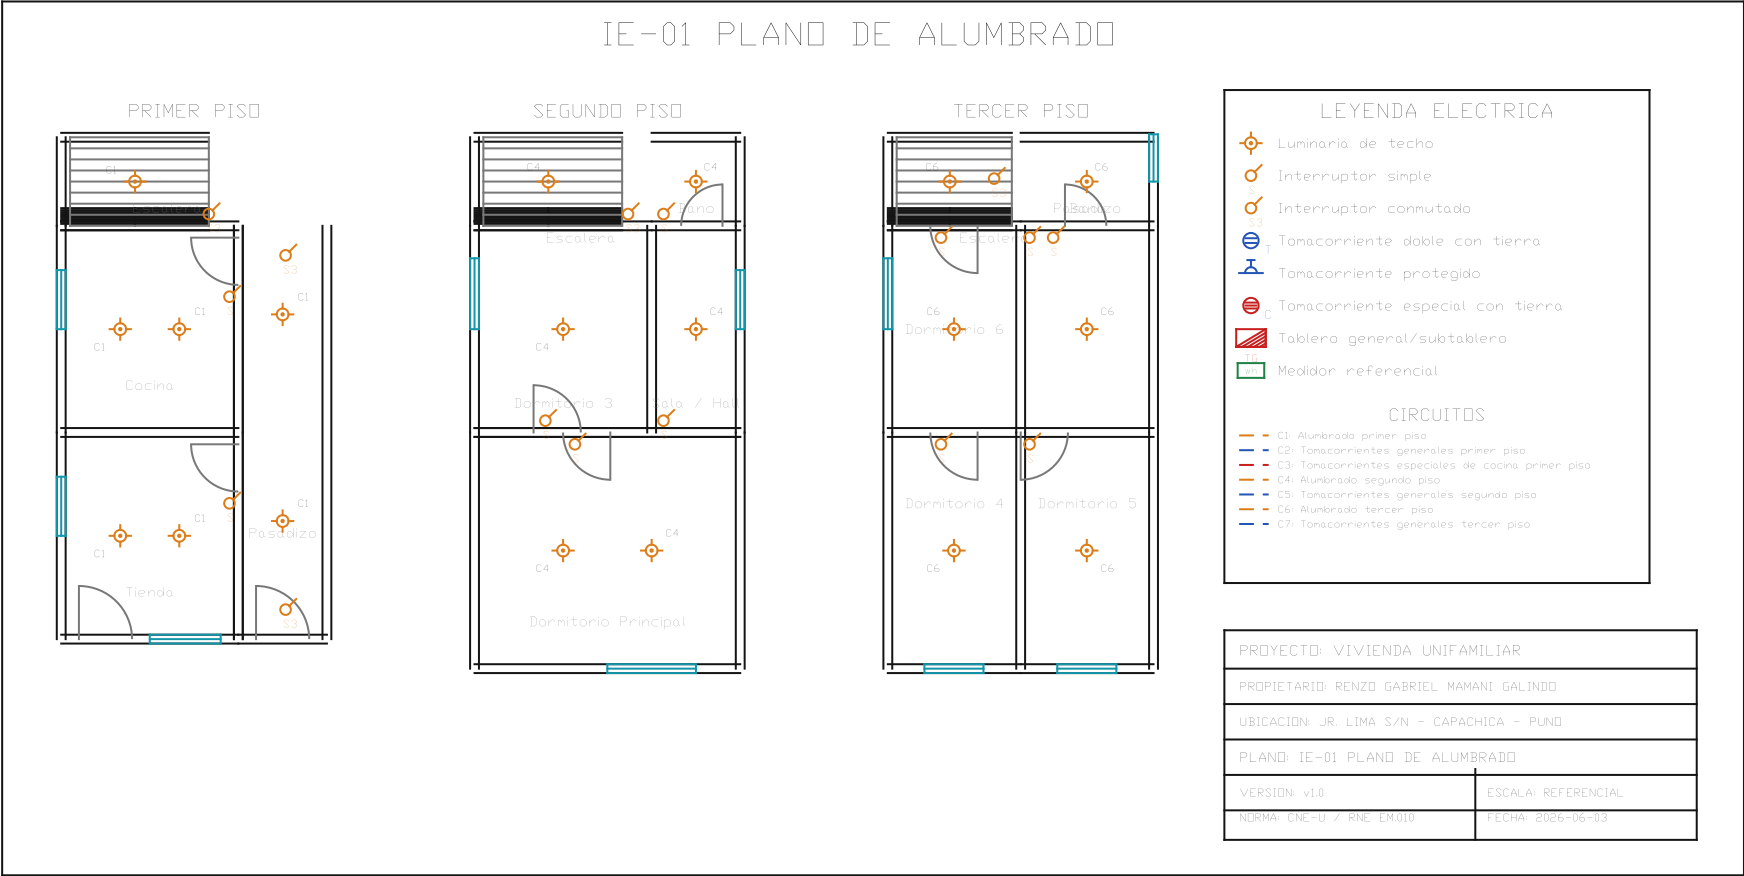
Plano de Instalaciones Eléctricas - Alumbrado (Consolidado)
